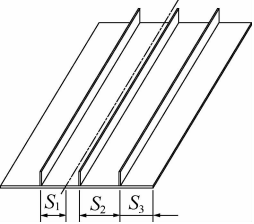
节点板焊缝错开的最小距离 (mm)
